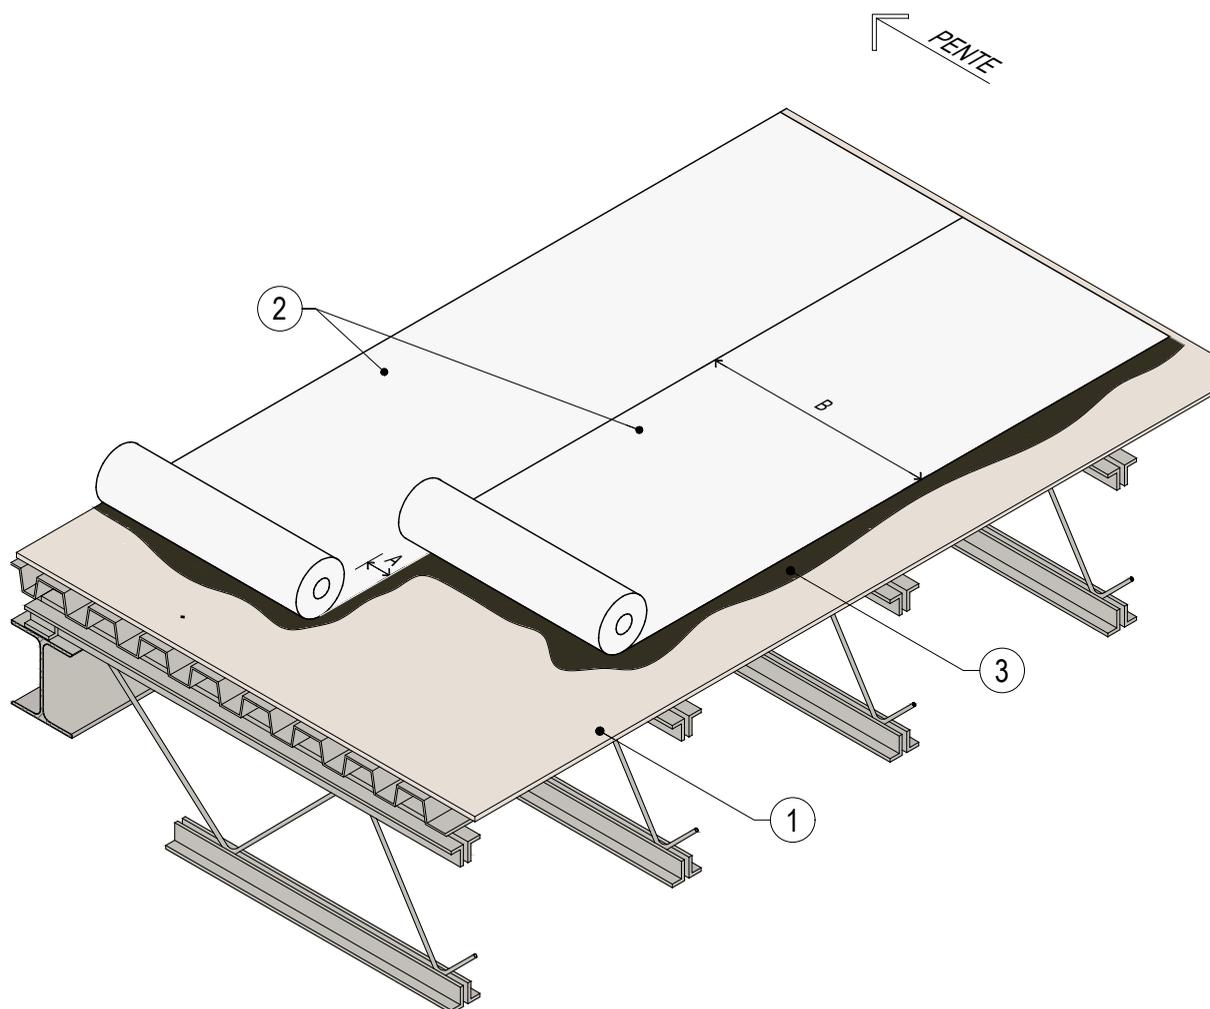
PLATELAGE D'ACIER DES TESTS D'ARRACHEMENT AU VENT
